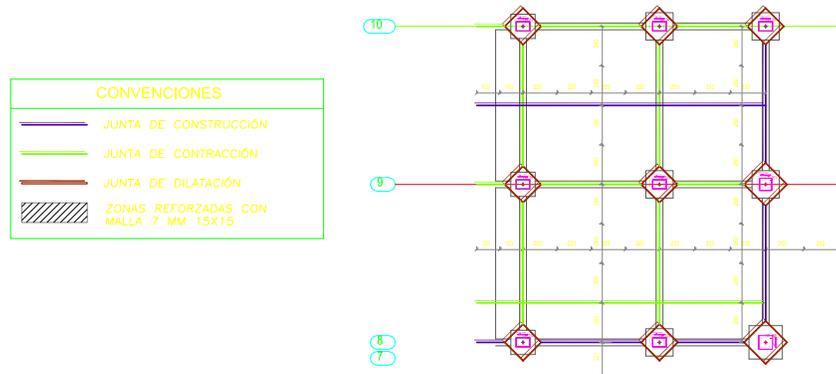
Detalle plano de juntas. (Fuente: departamento de diseño Metálicas e ingeniería S.A.)
